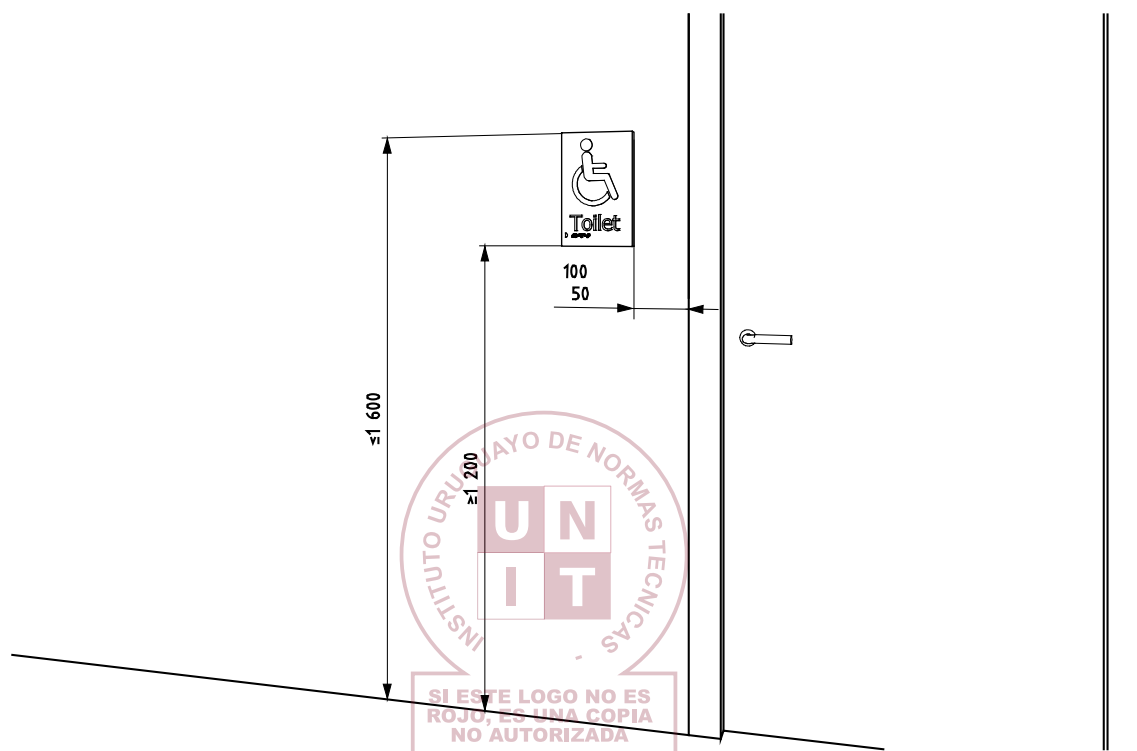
Ubicación de las señales del lado de la manija de la puerta
